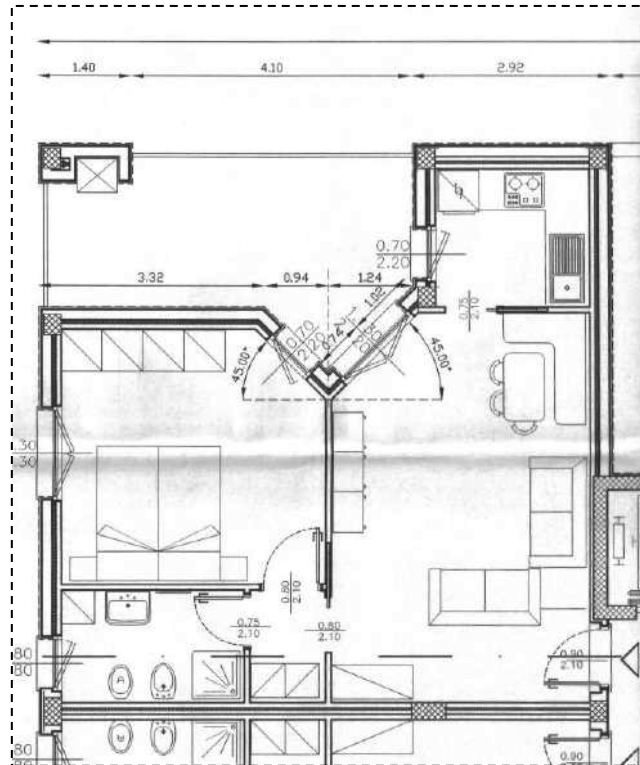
Subalterno 42 – Piano Primo – Planimetria stato di progetto
